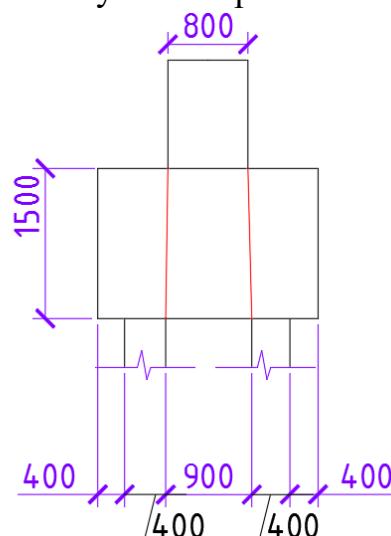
Схема для расчета ростверка на продавливание колонной
